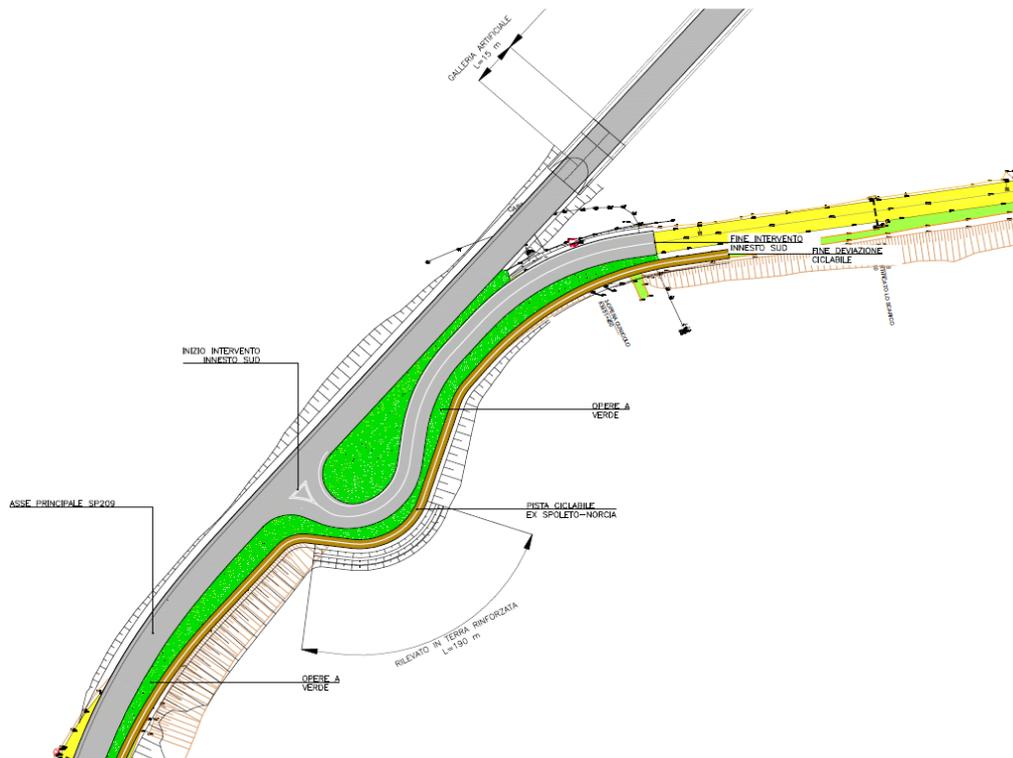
Stralcio planimetrico dell'intervento di deviazione della pista ciclabile
